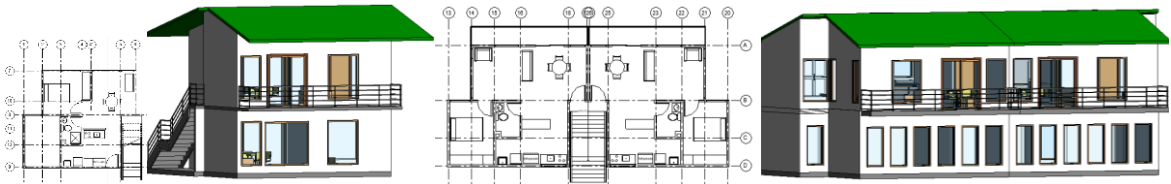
Planta y perspectiva de tipología unifamiliar. Fuente: Giraldo, K.
